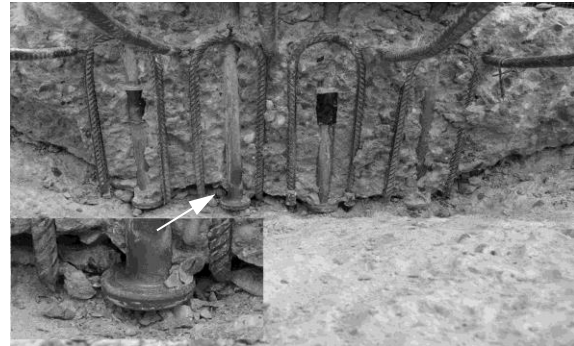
Duktileres Stahlversagen der Rückhängebewehrung im Betonausbruchkegel nach Kurz u.a. (2016)
